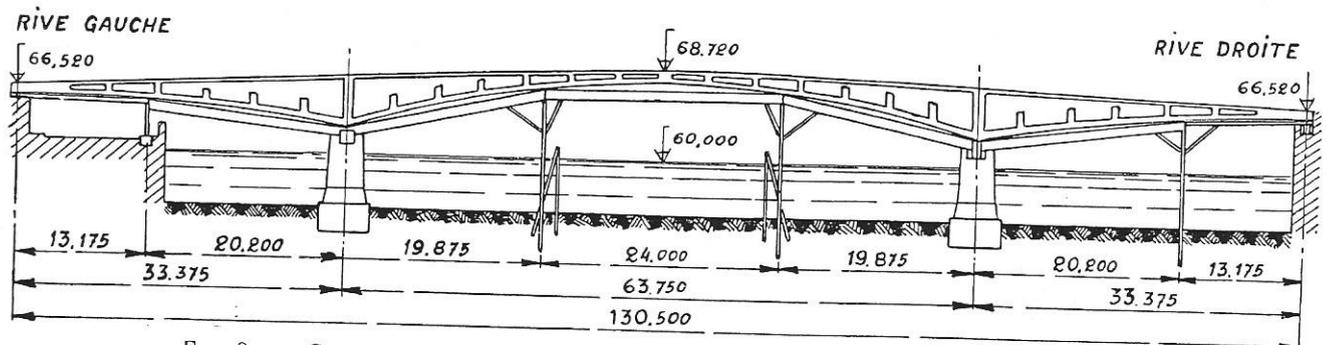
COUPE LONGITUDINALE montrant la disposition de l'échafaudage métallique utilisé pour la construction de la superstructure du pont.
